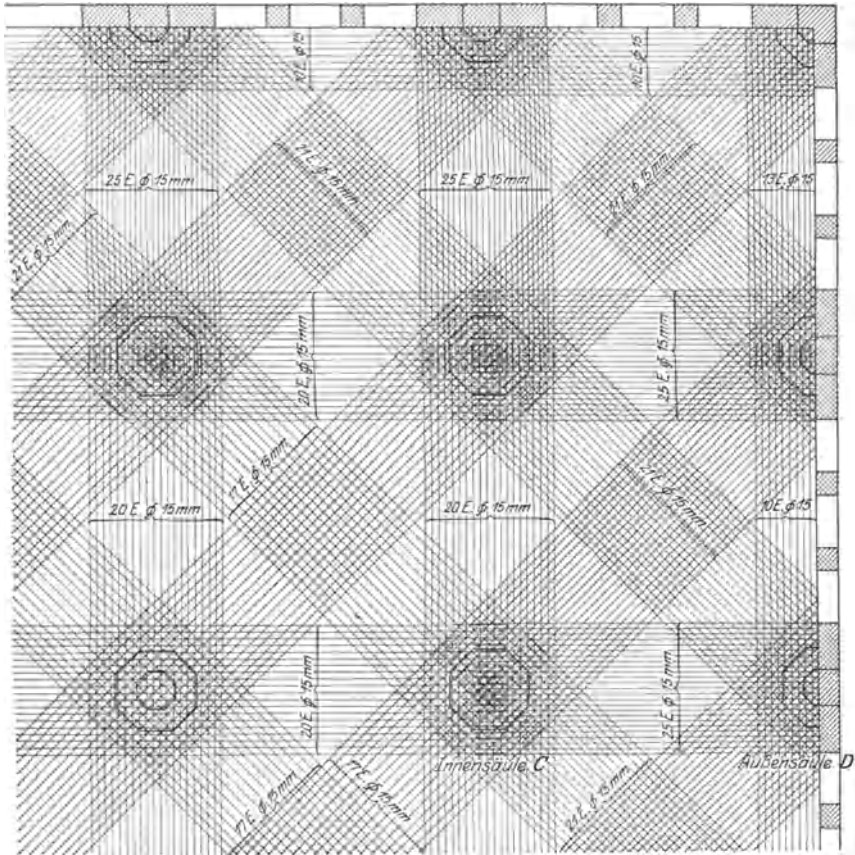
Grundriß der Decke über dem Kellergeschoß (Vierwegesystem).
